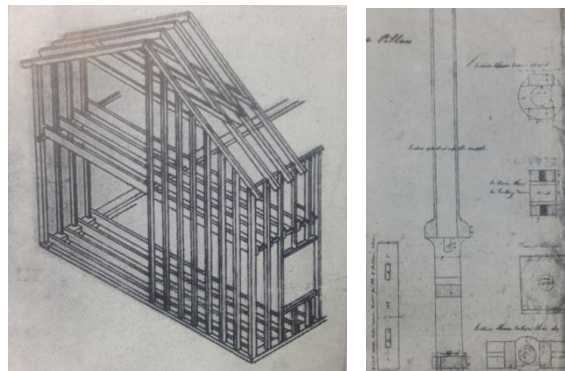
Esquema de la estructura tipo balloon- Figura 15: Destalle de pilar –dibujo de Boulton y Watt- del primer edificio de siete pisos construido con estructura de hierro fundido.
